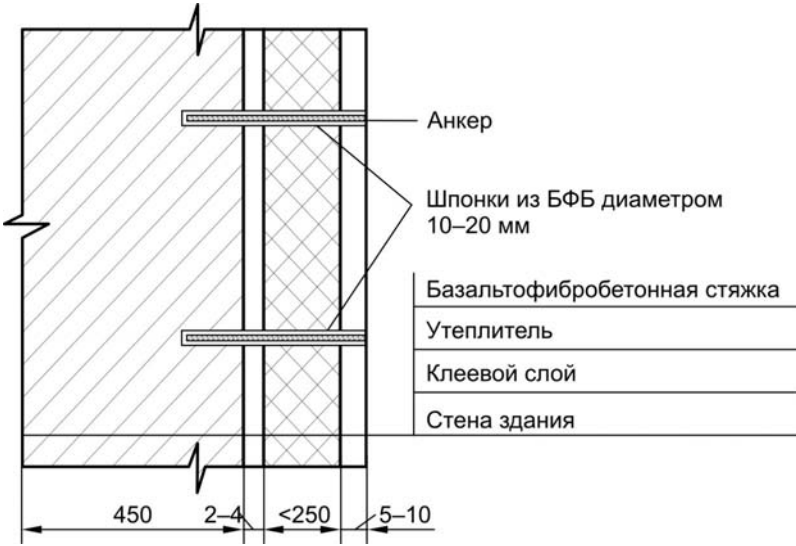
Конструктивная схема утепления наружных стен жилых панельных зданий жесткими пенополистиролбетонными плитами с базальтофибробетонной облицовкой
